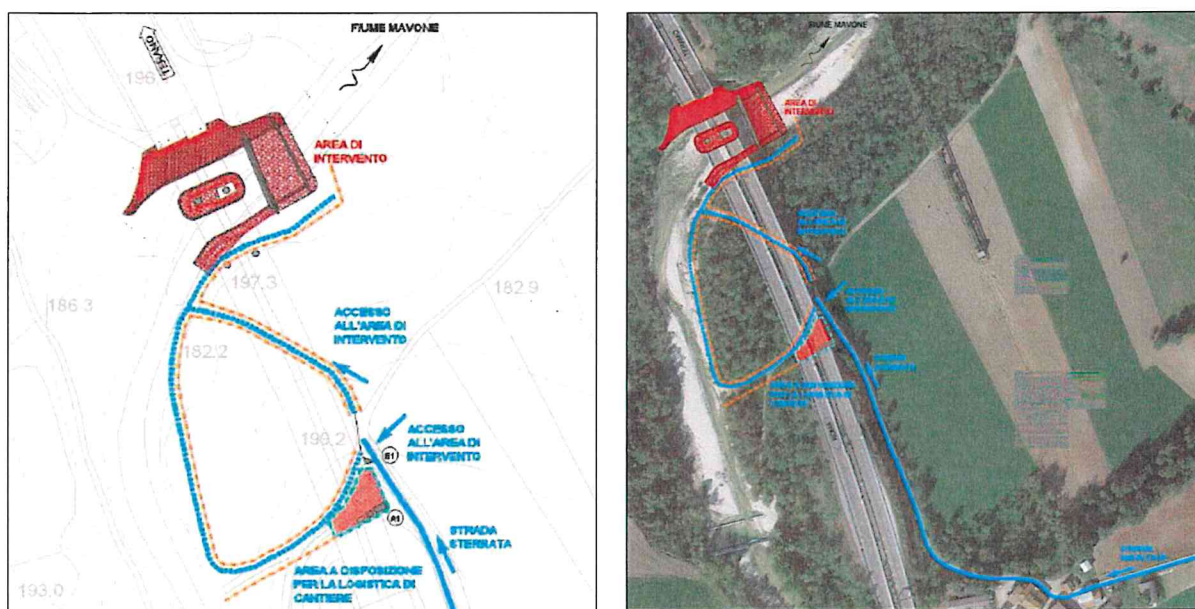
Stralcio planimetria di cantierizzazione (dallo SPA)
